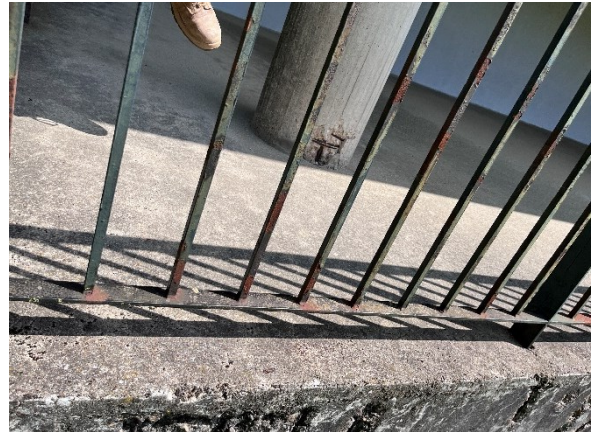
Corrosion sur garde-corps – Façade Est
